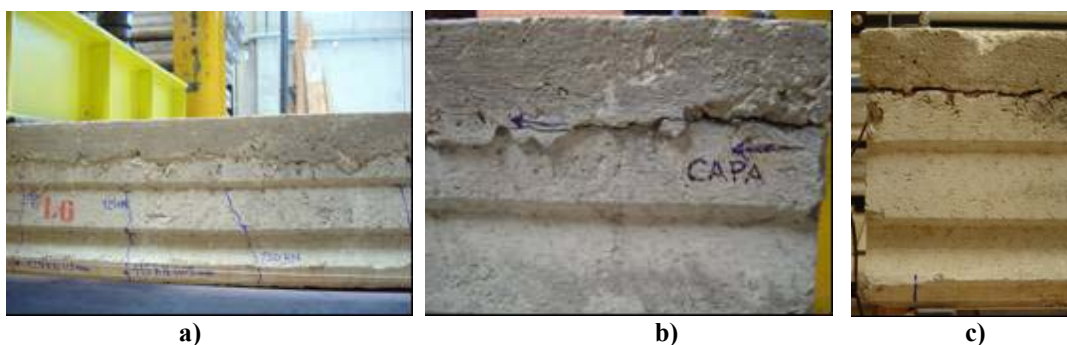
Configuração de fissuração da laje L14-20-CC-8_B: a) Vista lateral da laje; b) e c) Descolamento da capa nos apoios.
